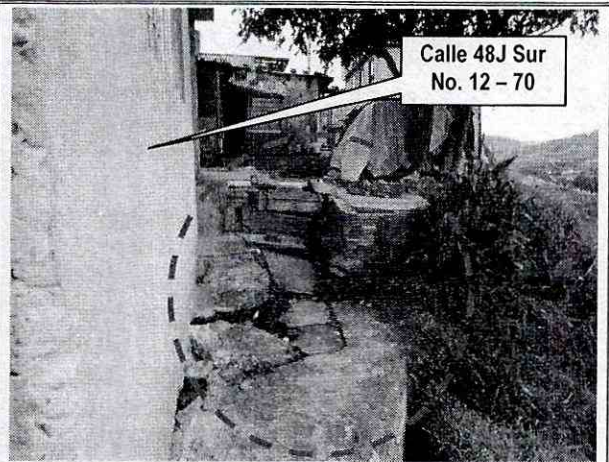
Detalle de la vivienda construida con material de recuperación, y las grietas evidenciadas en la cimentación.
